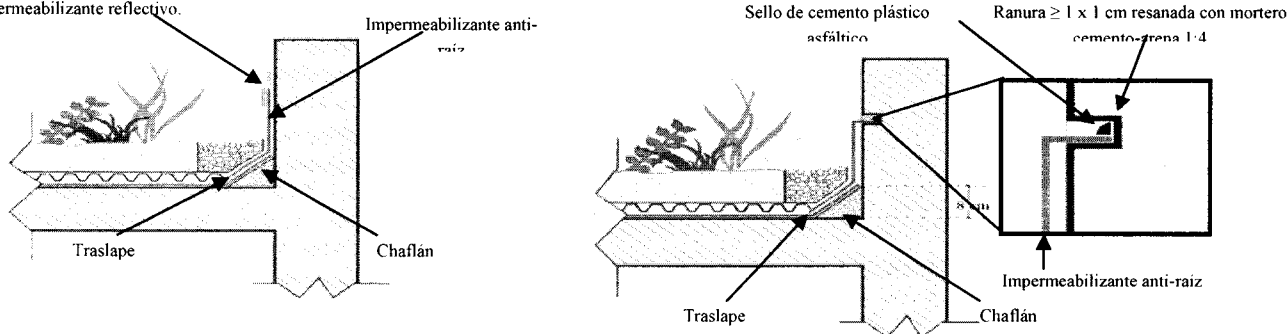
Impermeabilización con membrana prefabricada asfáltica en puntos de encuentro con pretilas y elementos emergentes perimetrales.
